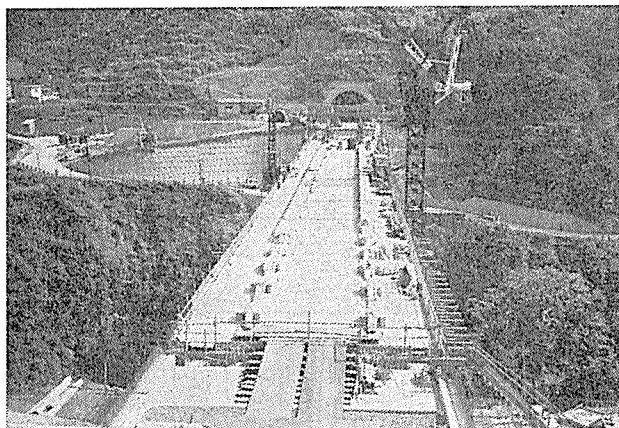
片側張出し施工中（緊張後のアウトケーブルの防護カバー）
